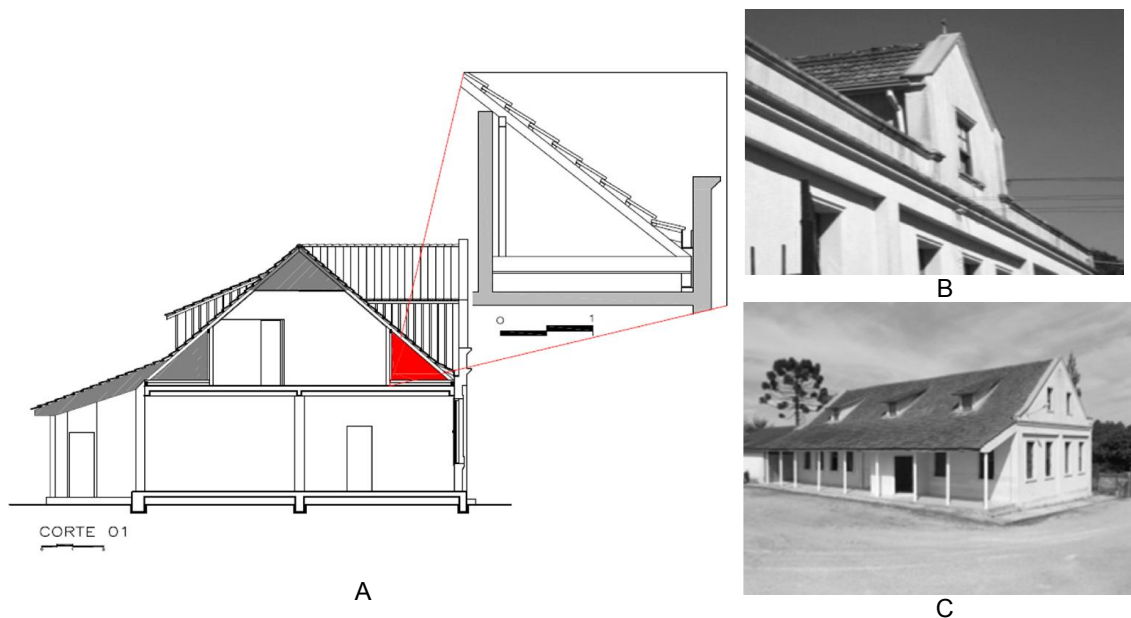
CASA DA CULTURA, CORTE E DETALHE DO TELHADO (A), FACHADA FRONTAL, MANSARDA CENTRAL (B), FACHADA POSTERIOR VISTA DAS 3 LUCARNAS (C).
